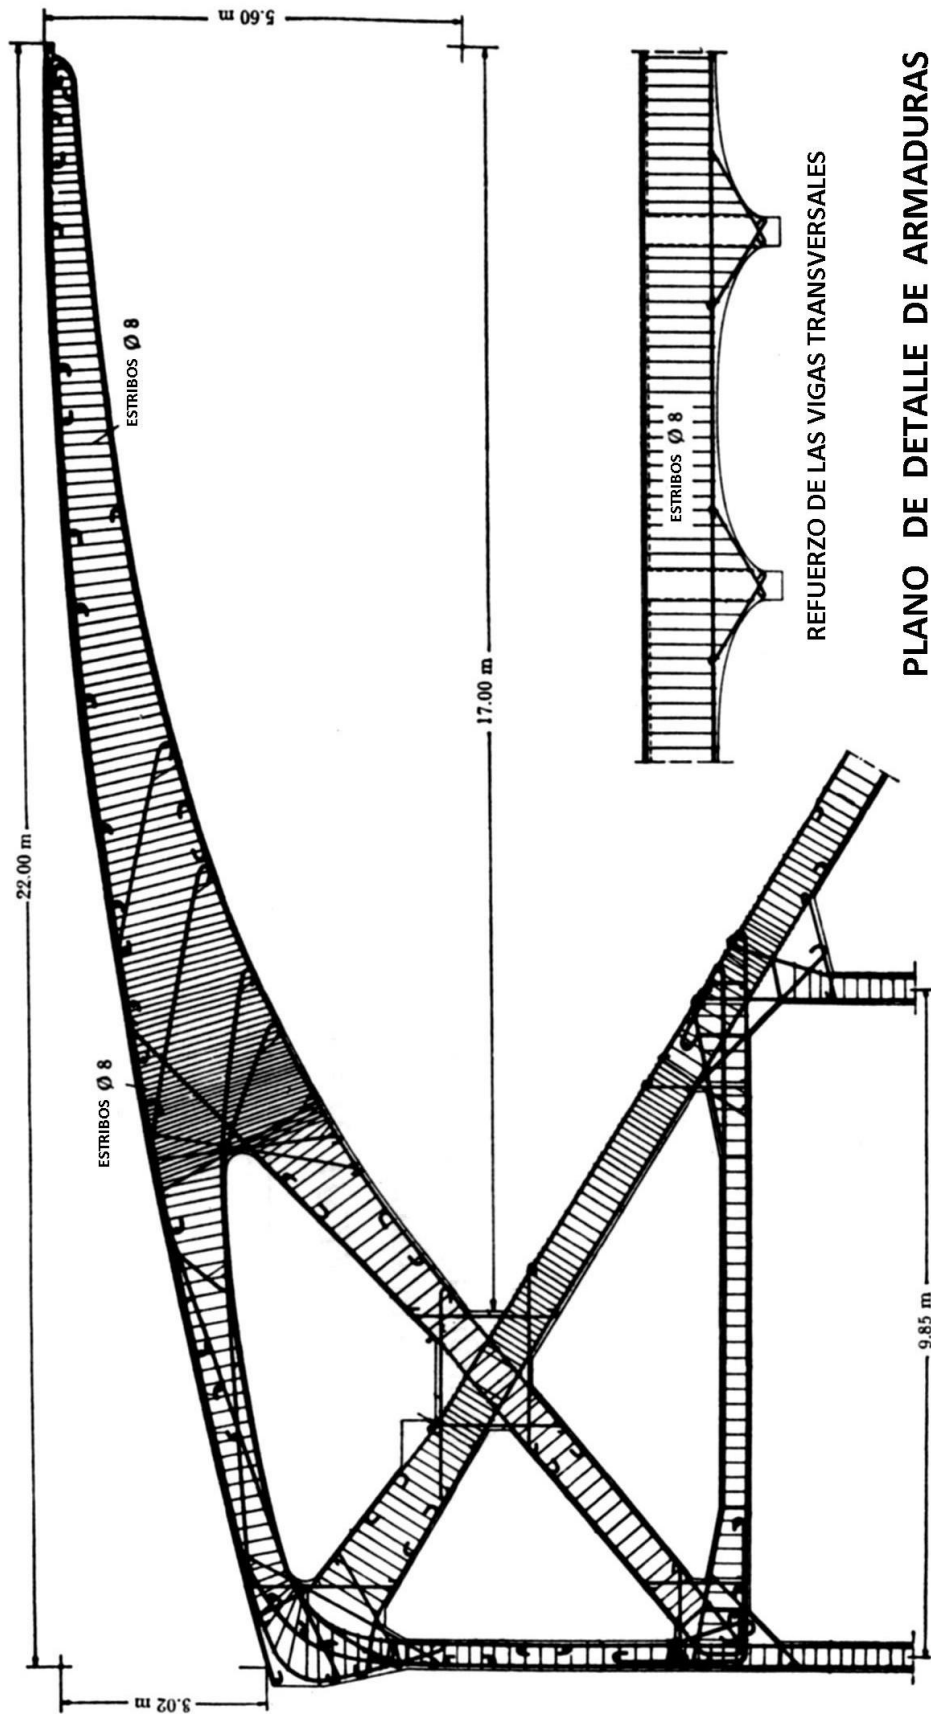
Plano del armado general de la estructura del graderío y marquesina, mostrada por la sección transversal (longitudinal de las vigas del voladizo) del Estadio Comunal de Firenze. (Pier Luigi Nervi, *Structures*. F. W. Dodge Corporation: New York 1956).
